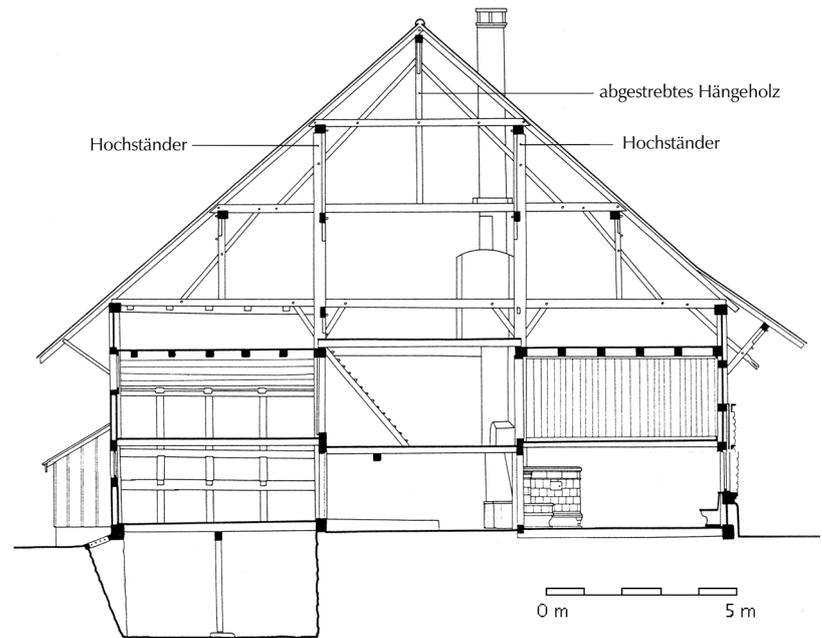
Hochständergerüst mit abgestrebtem Hängewerk im 2. Dachgeschoss. Kloten (Kt. Zürich), „Büchelerhaus“, 1548 (i).
